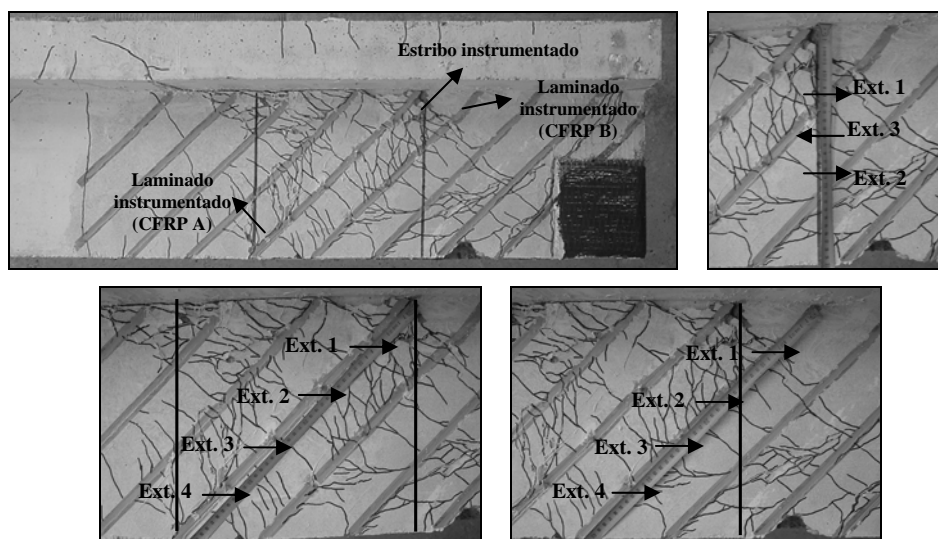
Localização dos extensómetros no laminado e estribo instrumentados da viga 2S-10LI45-B.
